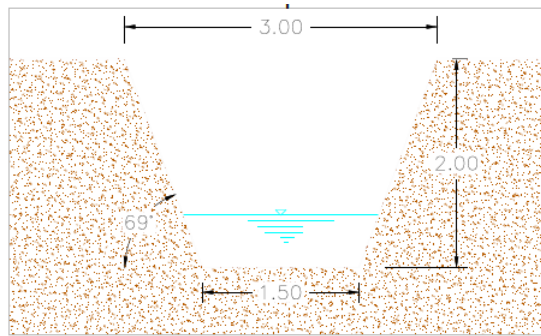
Canale di laminazione Gronda Sud – Sezione tipo – Stralcio tavola progettuale
